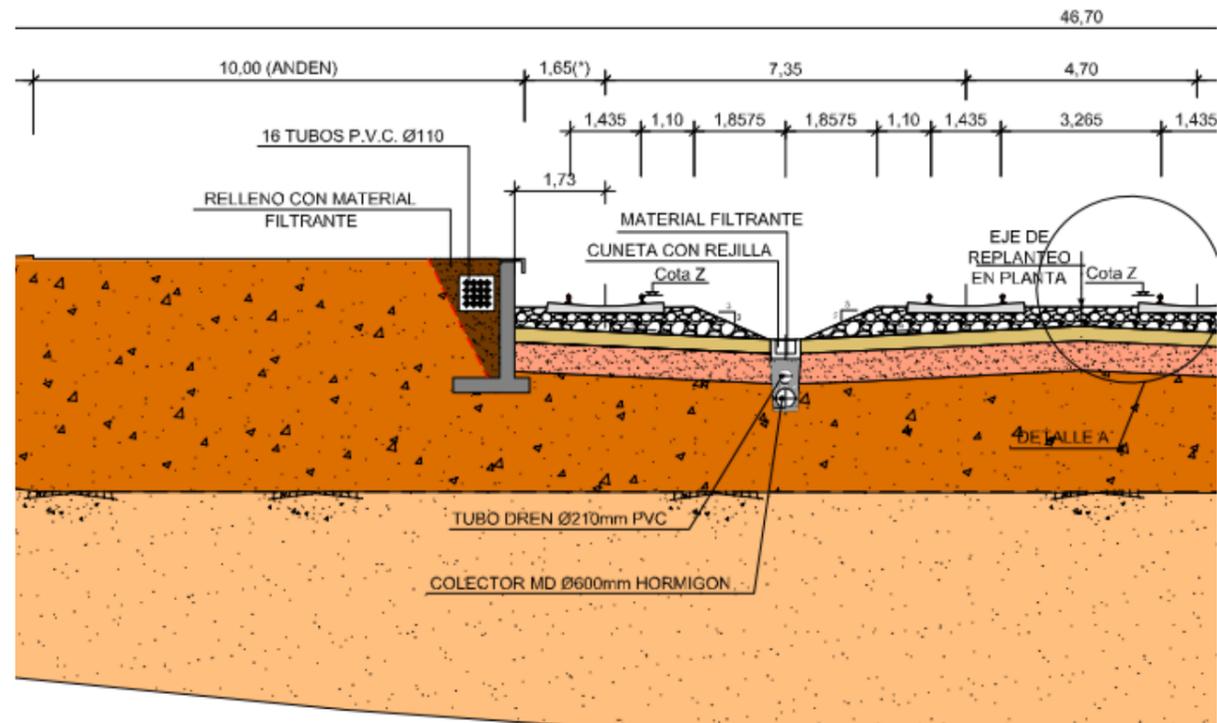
DETALLE SECCIÓN TIPO ESTACIÓN ELCHE AV
